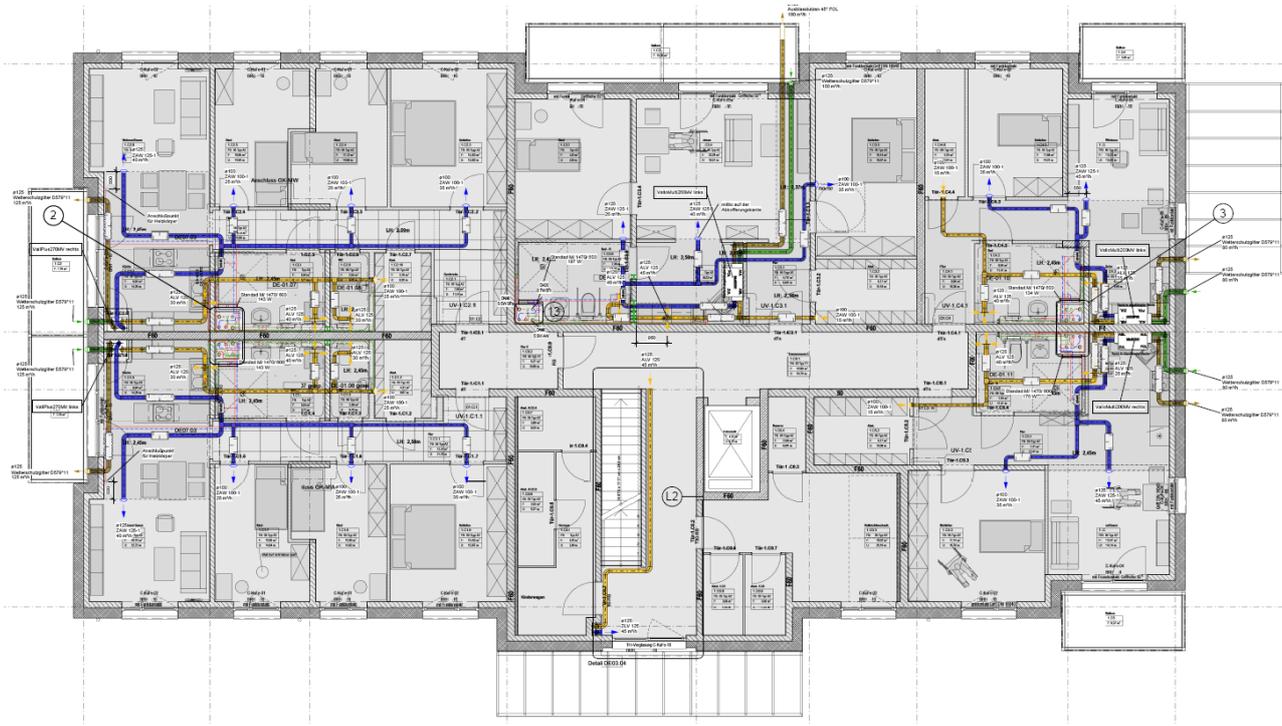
zeigt den Grundriss im 1. Obergeschoss im Bestandsgebäude und Bild 10 den Grundriss im Neubau. Abgebildet sind jeweils die Pläne mit den Lüftungskanälen (Quelle [ibs Energie 2019]).
